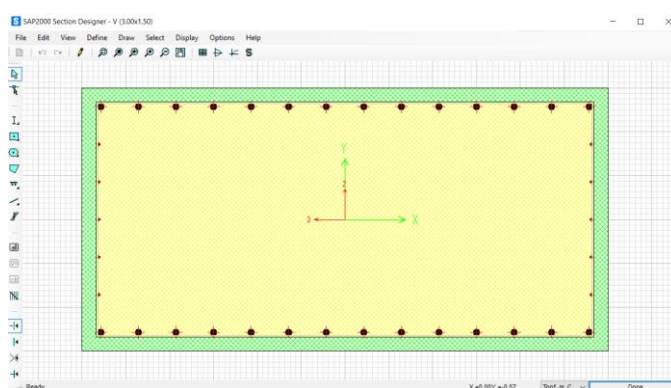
Sección de viga cabezal con refuerzo (2.00mx1.50m)
